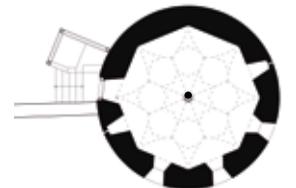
Grundriss Auer 2013. M 1:400.
